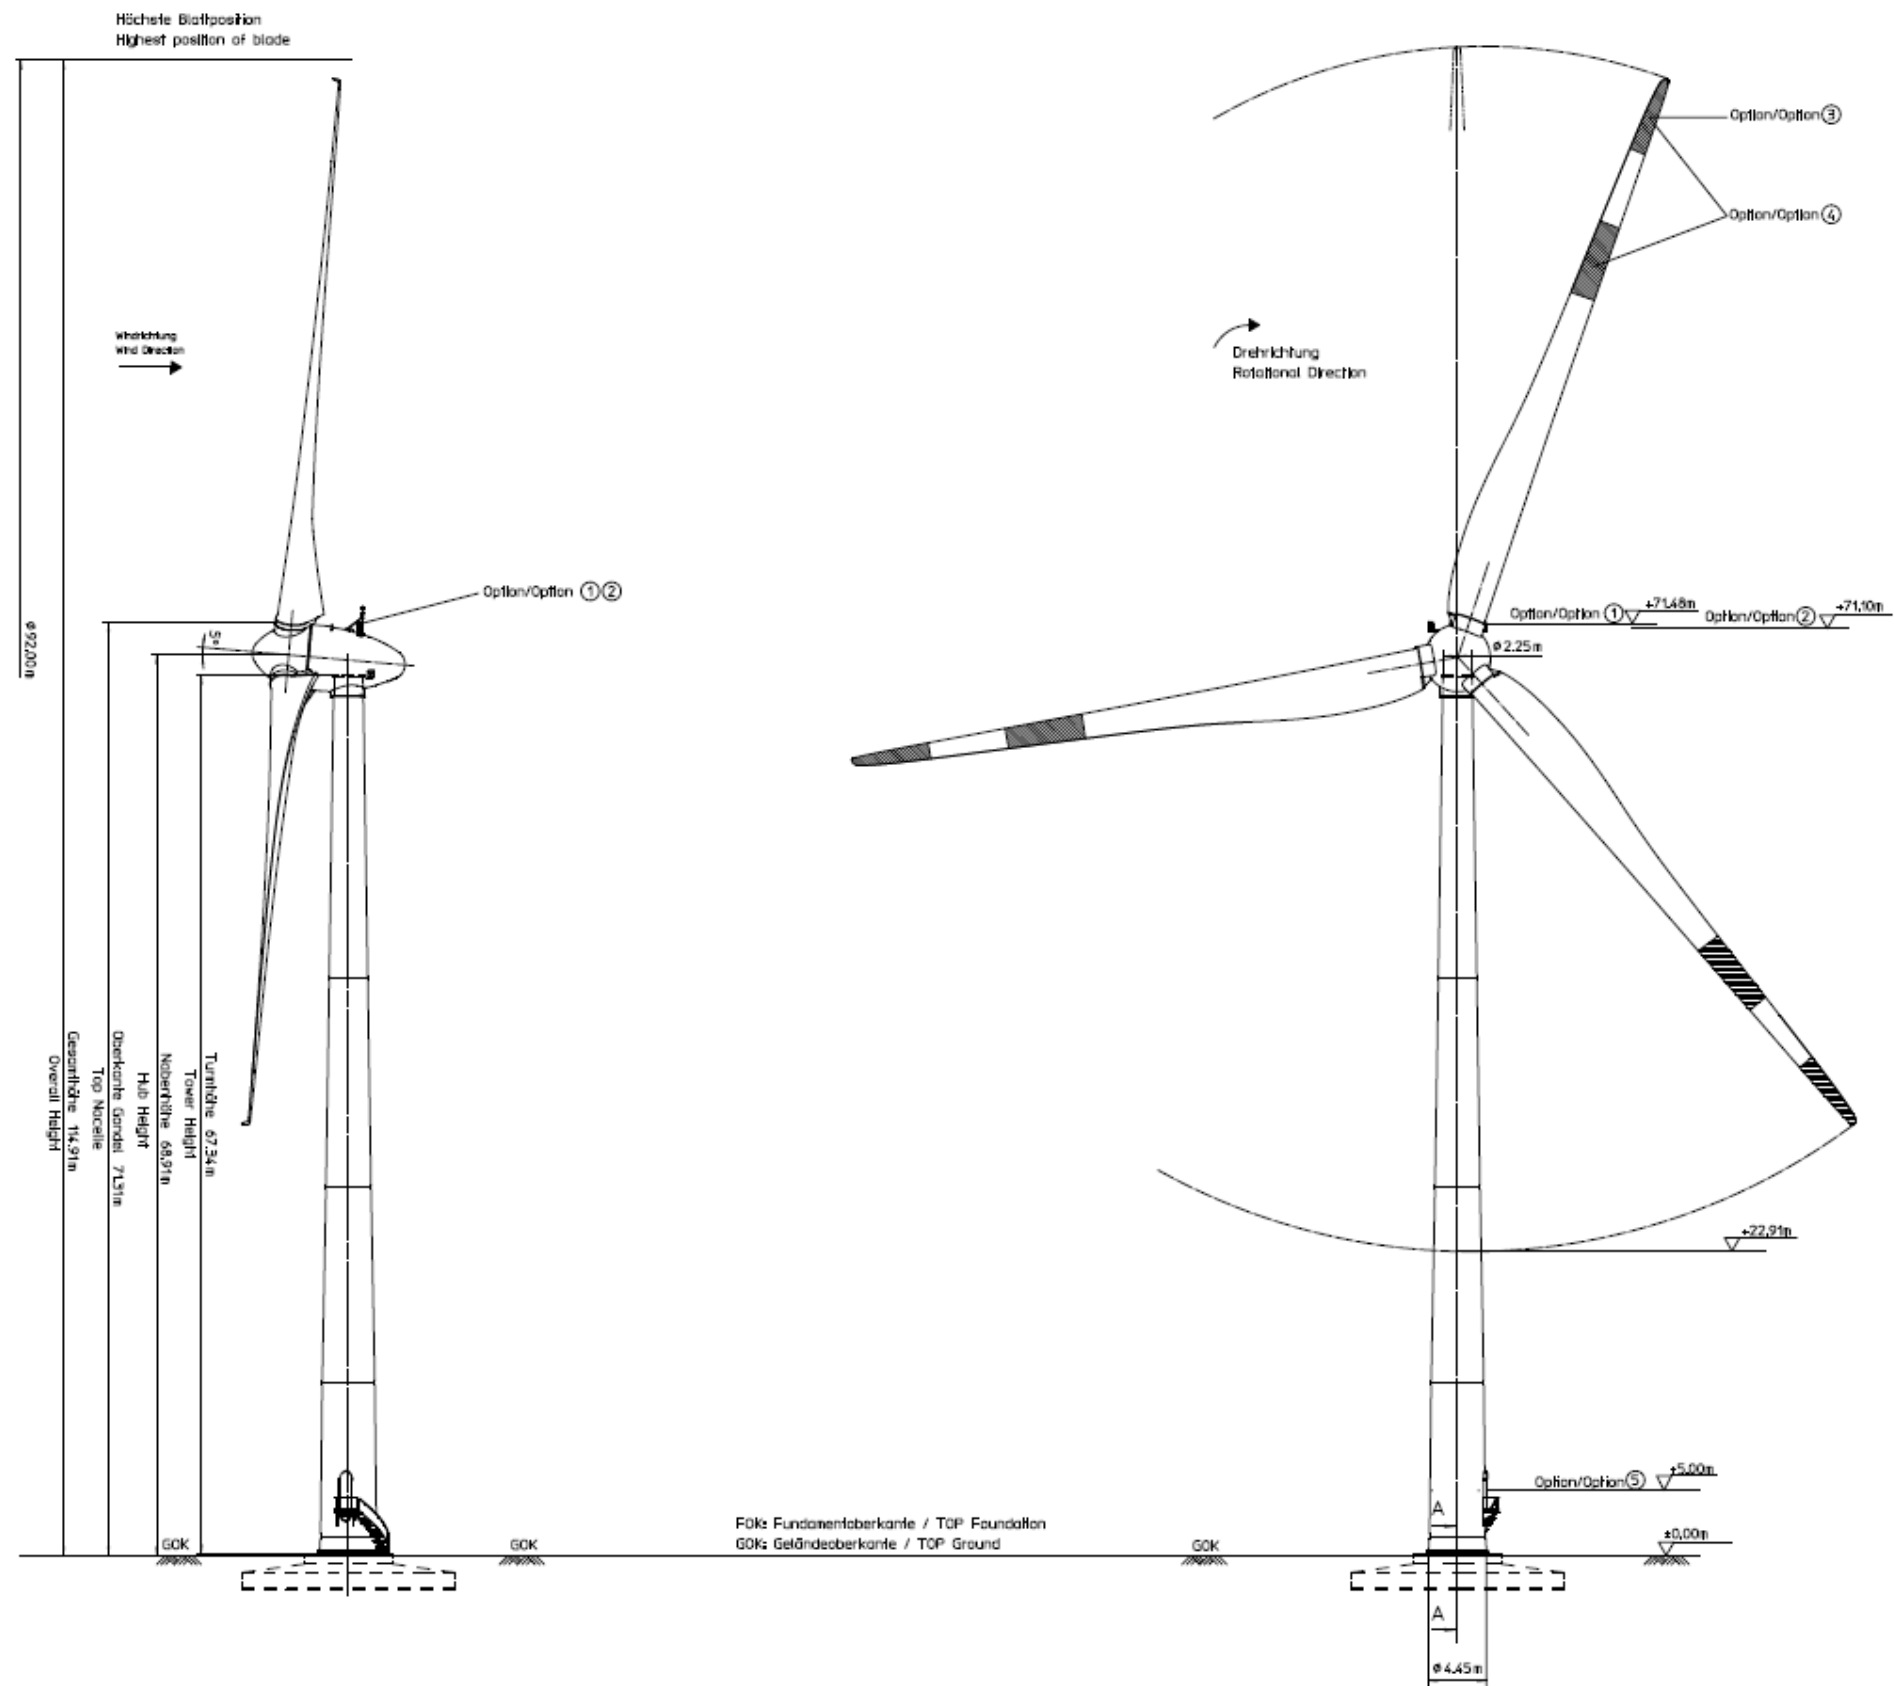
Plans de l'éolienne E92-2.35 MW avec une hauteur de moyeu de 69 m
